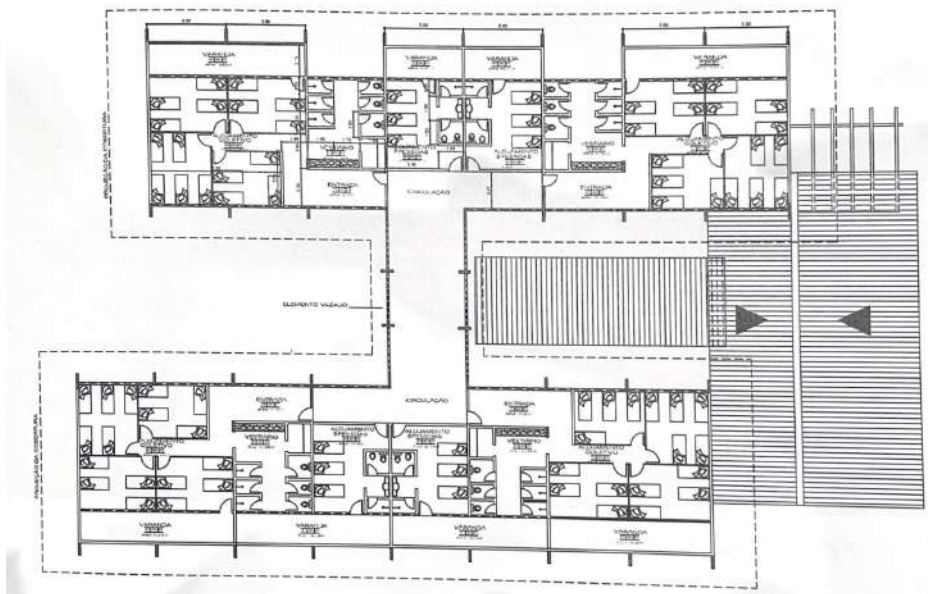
Segundo pavimento do Hotel, Fonte: BRITTO,2018
